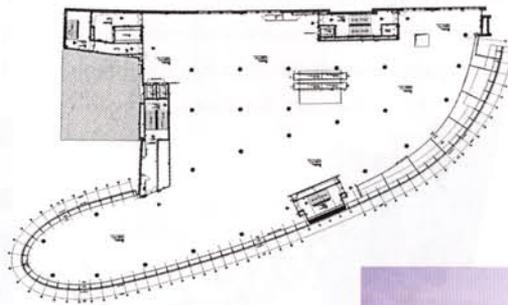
Grundriss des Kaufhauses. Gebäude-maße: 130 m × 60 m
